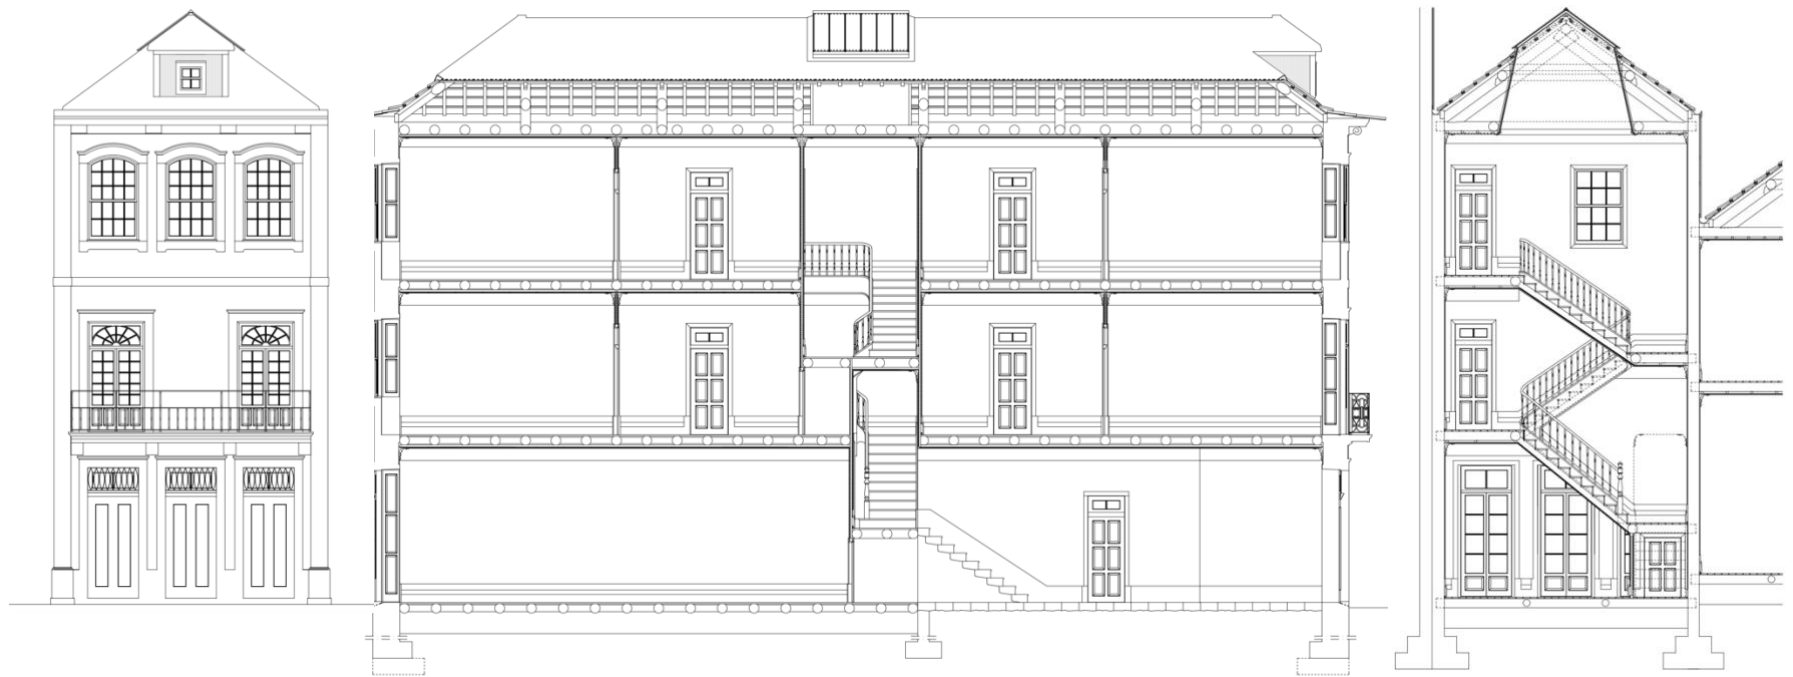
Alçado principal, corte longitudinal e corte transversal da casa Iluminista (extraído de Teixeira: 2013).
